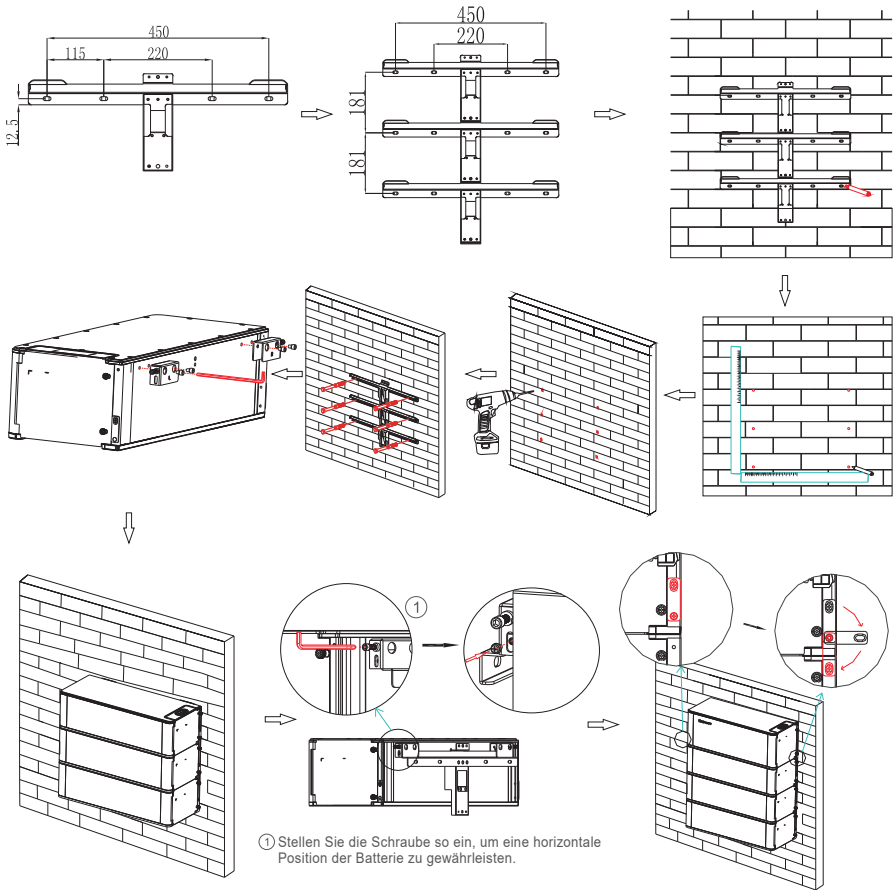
Installationsverfahren für mehrere Batterien mit Wandhalterung.
